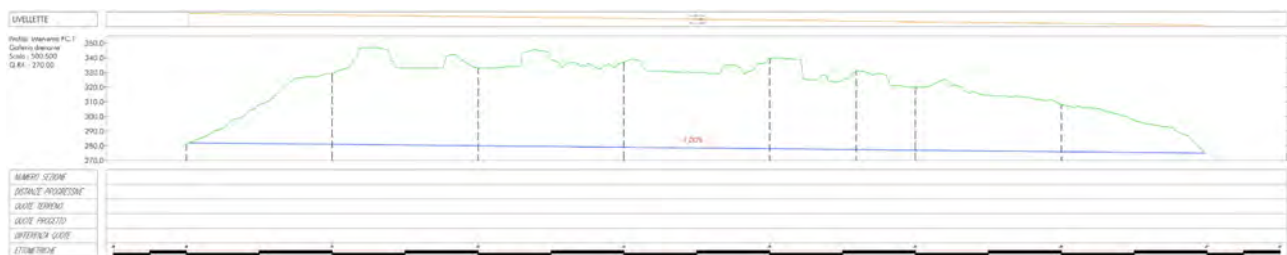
Profilo altimetrico d'asse dell'orizzontamento inferiore della galleria drenante.
